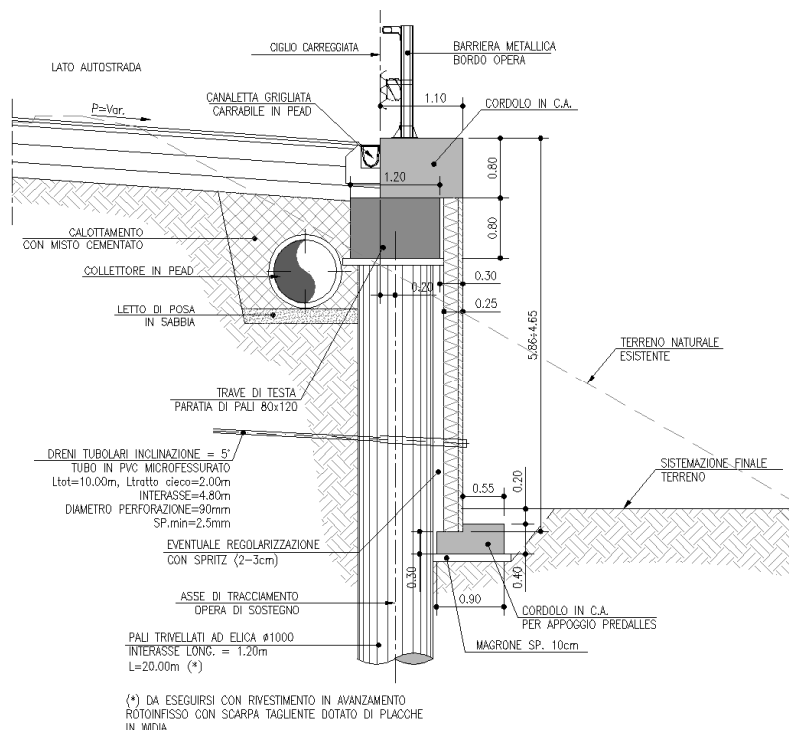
Sezione tipo opera di sostegno MS010 – Tratto 1
